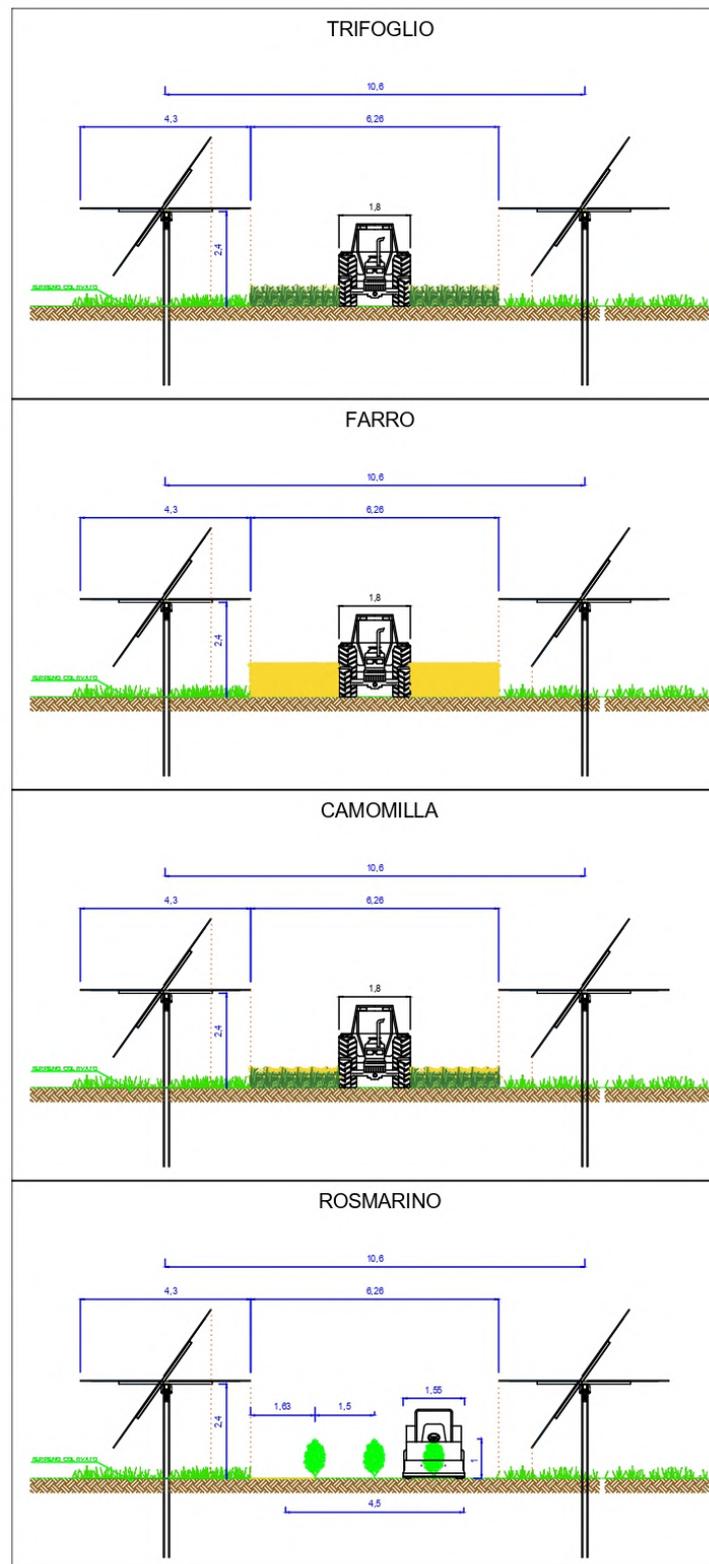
Rappresentazione del prospetto frontale delle colture
